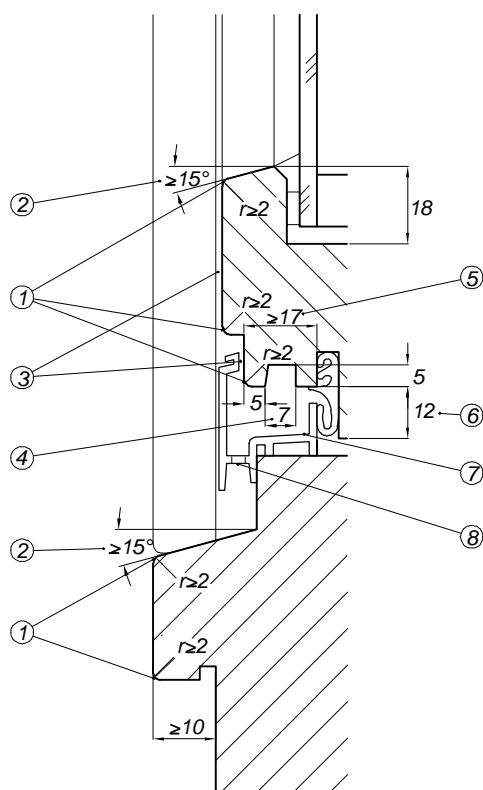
Grundlegende Details zur Wasserabführung aus der Konstruktion
